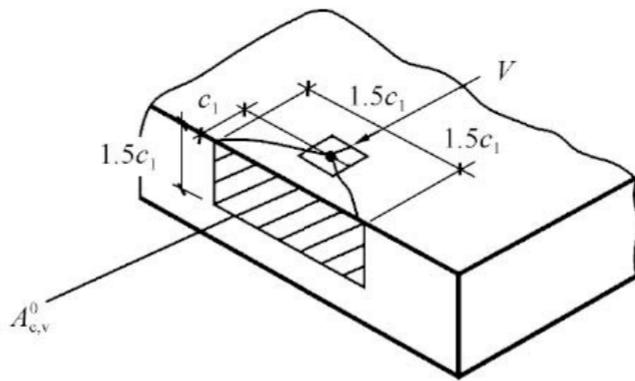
近构件边缘的单锚受剪混凝土楔形投影面积
